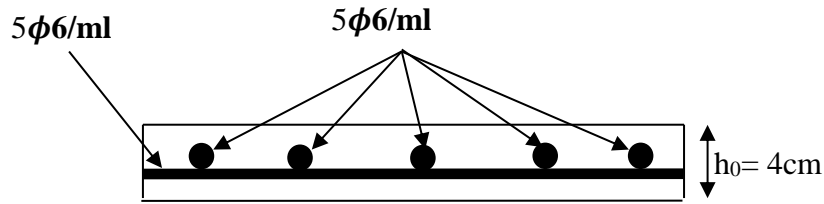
Schéma de ferrailage de la dalle de compression.
